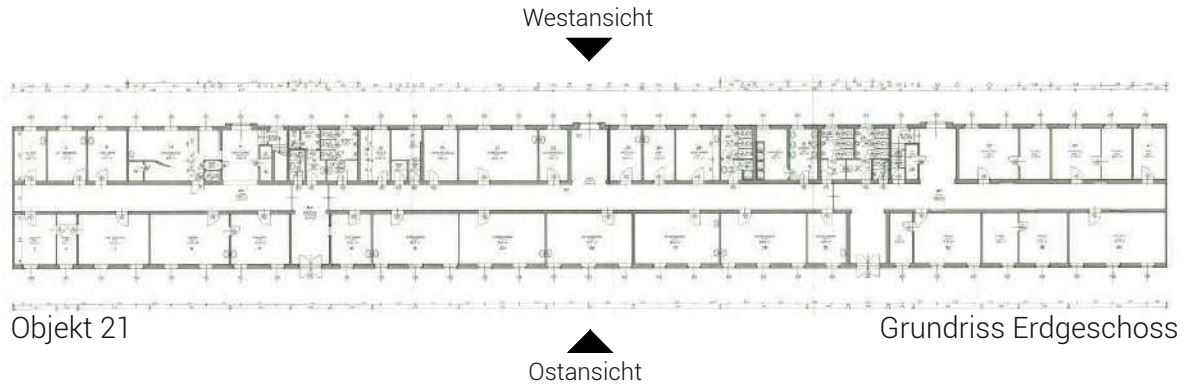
Grundriss Heeressanitätsanstalt Martinekkaserne
